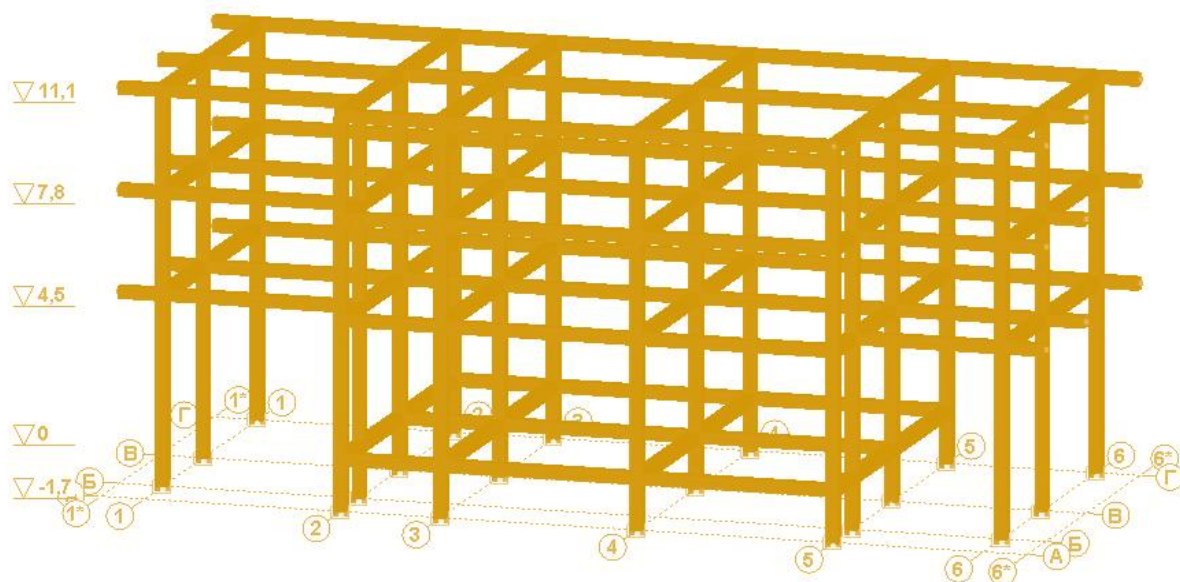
Просторова розрахункова схема каркаса будівлі
